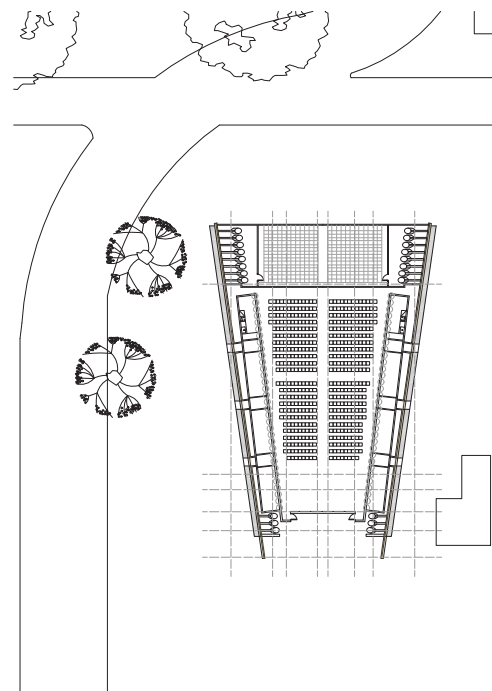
Planta Catedral de Cartón. Escala 1:1000
